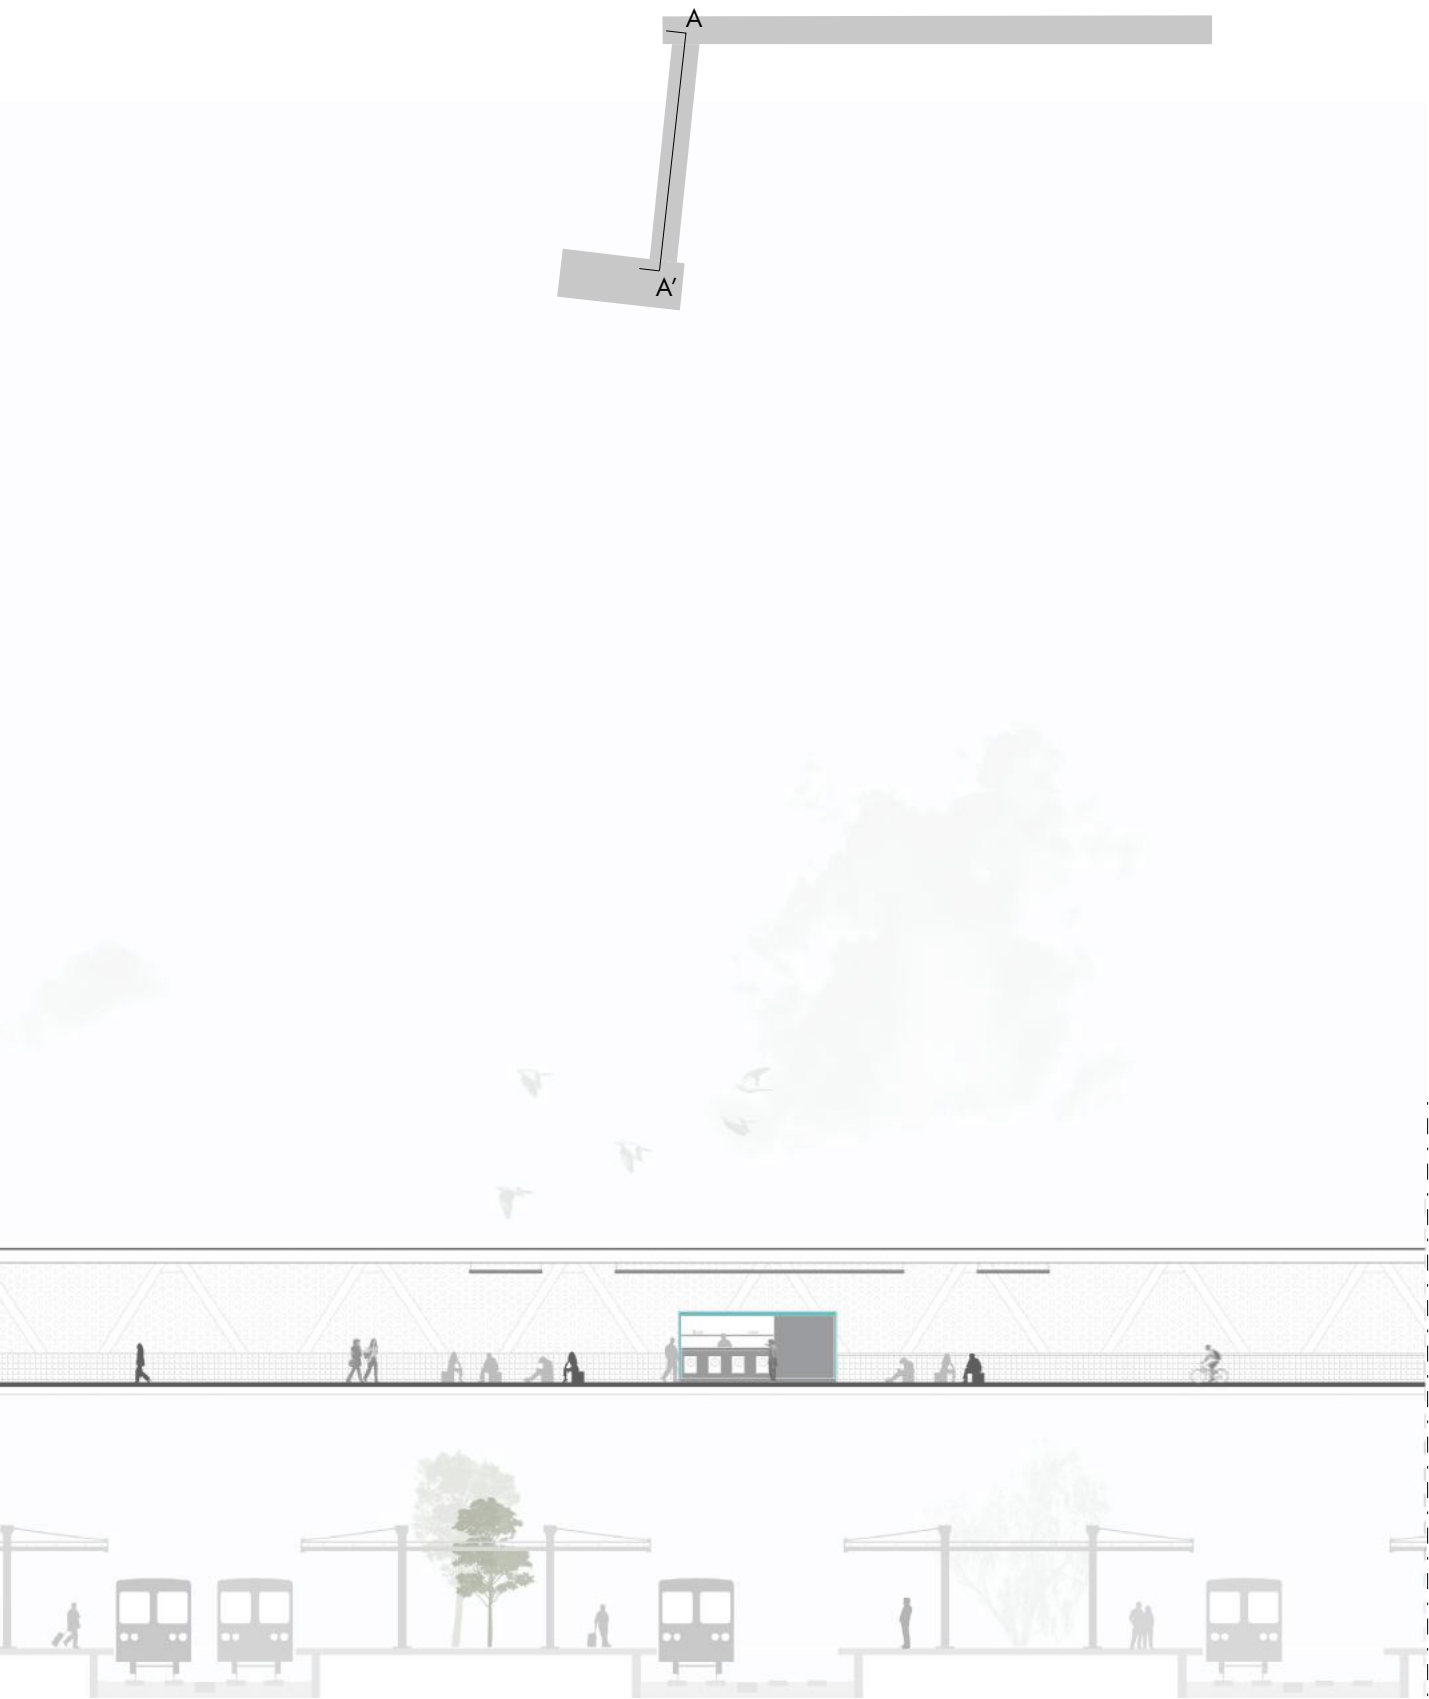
Primo tratto della passerella con vista serale della discoteca; sezione AA'
